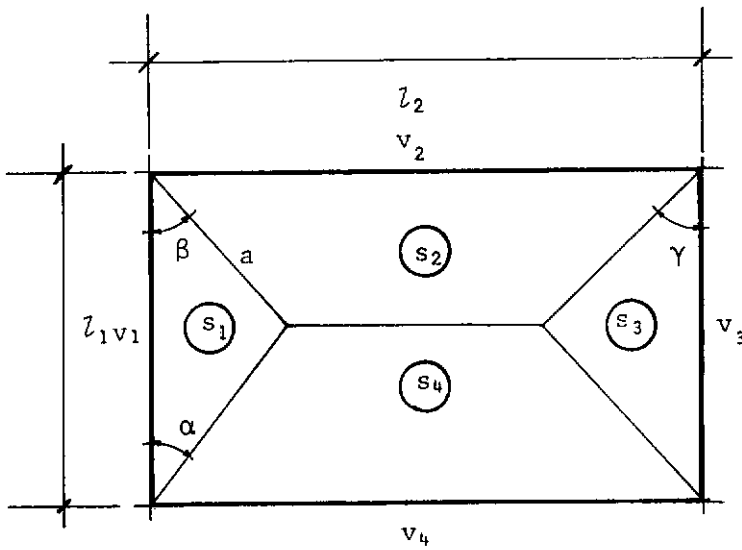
Áreas Contribuintes à Cada Viga.
